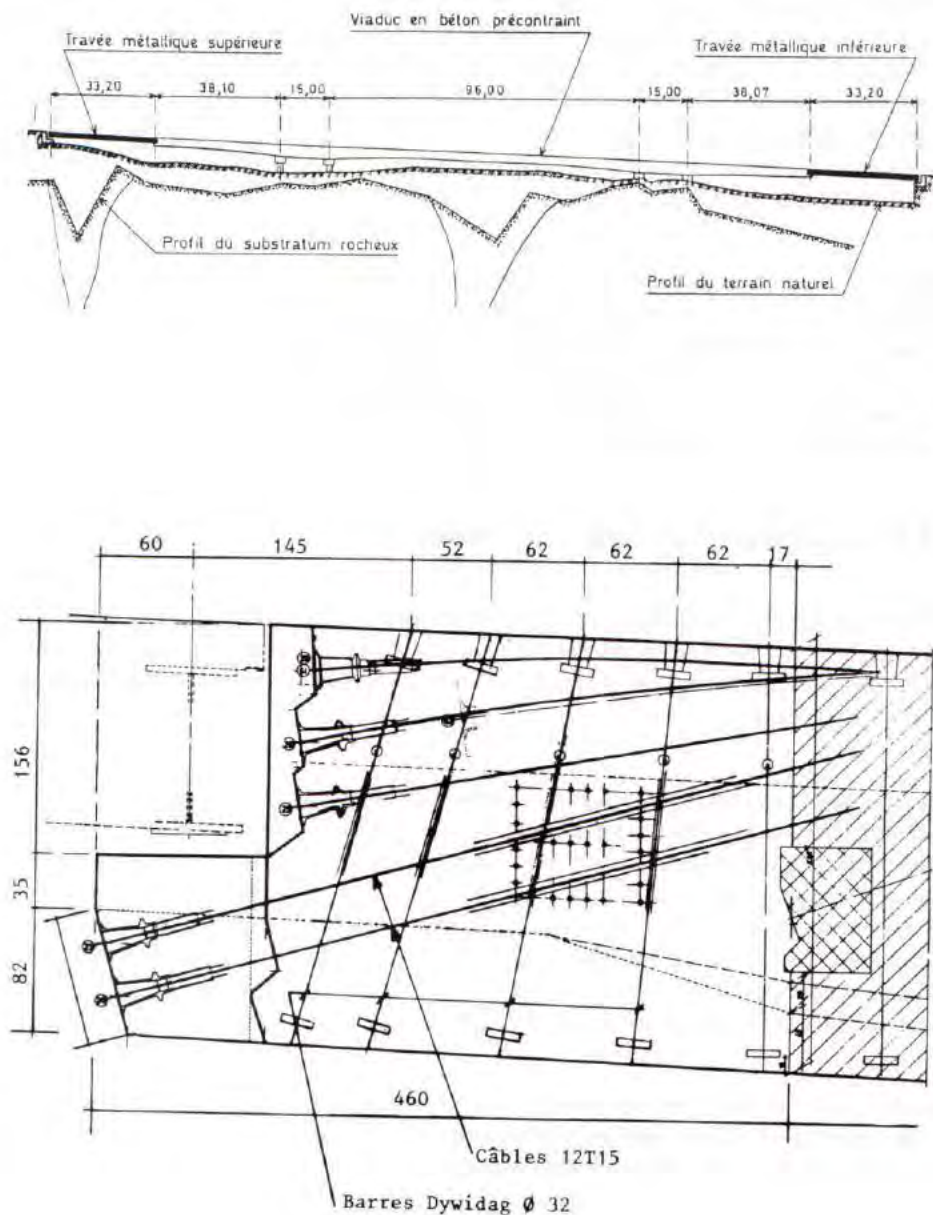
Viaduc de Fourneaux sur la route d'accès au tunnel routier du Fréjus.
